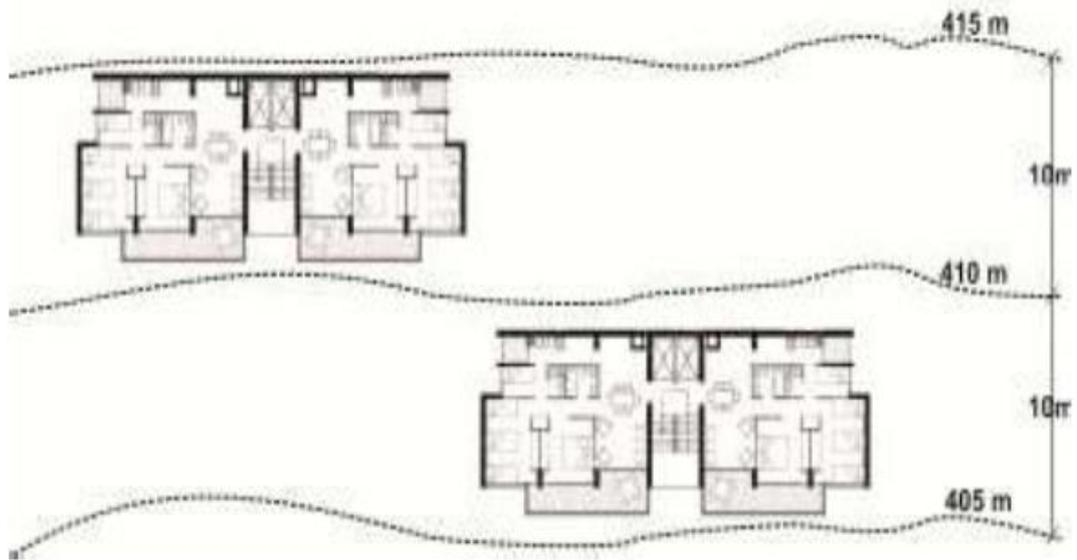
Arquitectura modificada: Planta sugerida para planta de departamentos
